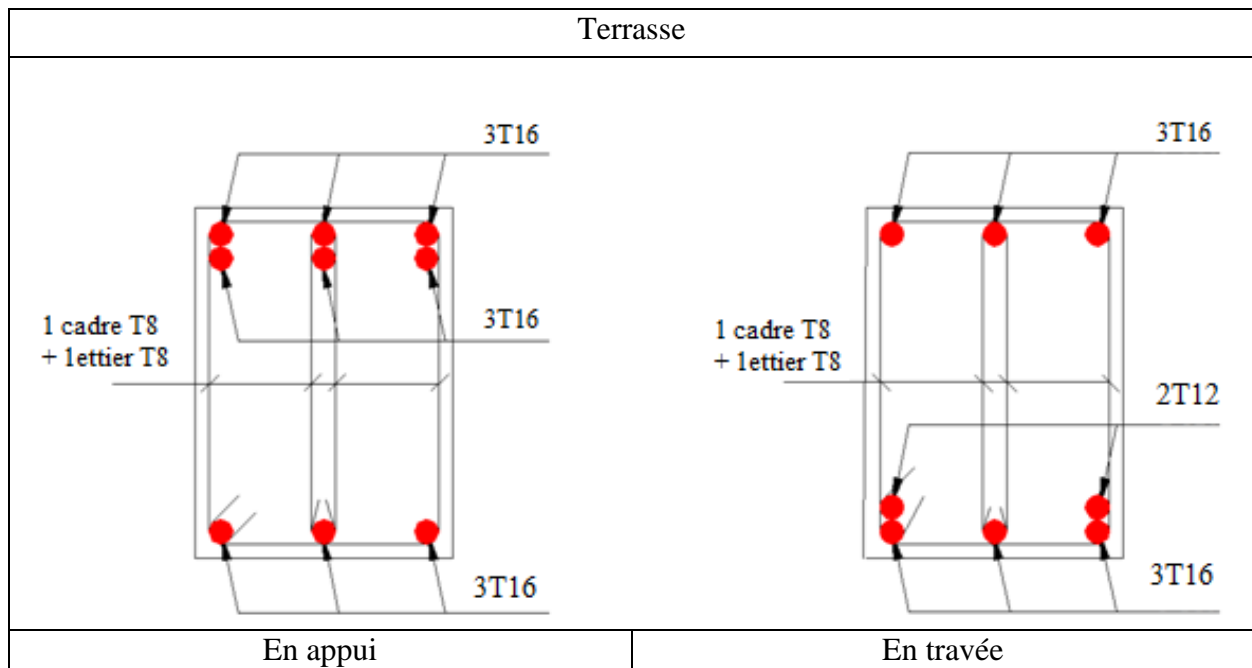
Ferraillage des Poutres porteuses de la terrasse
